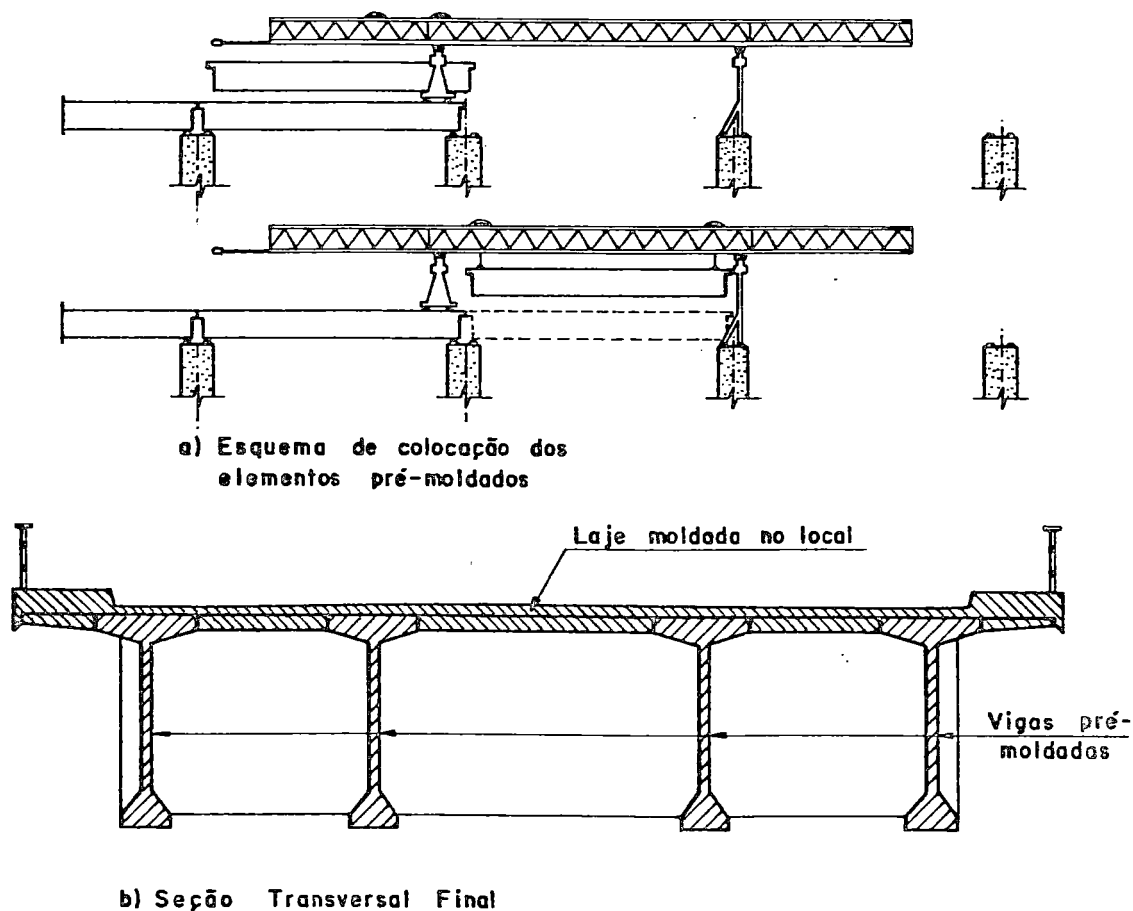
ILUSTRAÇÃO DA CONSTRUÇÃO DE PONTES
